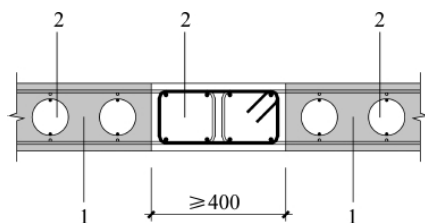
灌芯混凝土剪力墙墙身连接区域后浇构造示意
